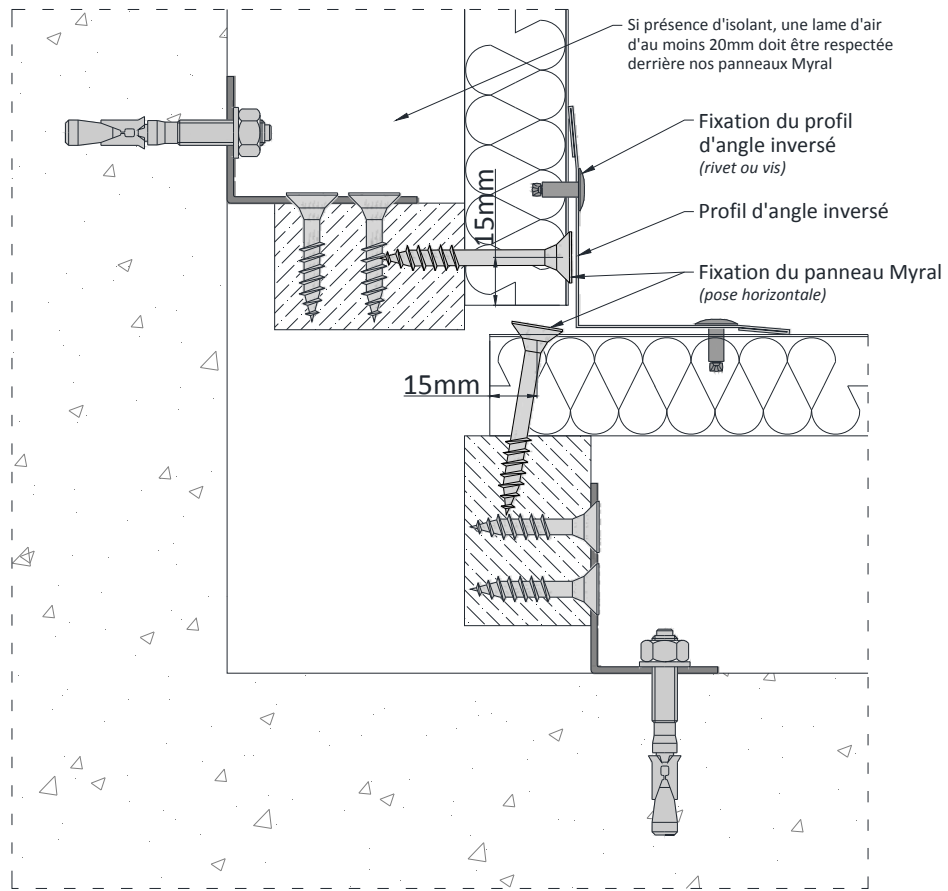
1 - Angle rentrant – Pose en bardage rapporté simple réseau, pose horizontale (coupe horizontale)
